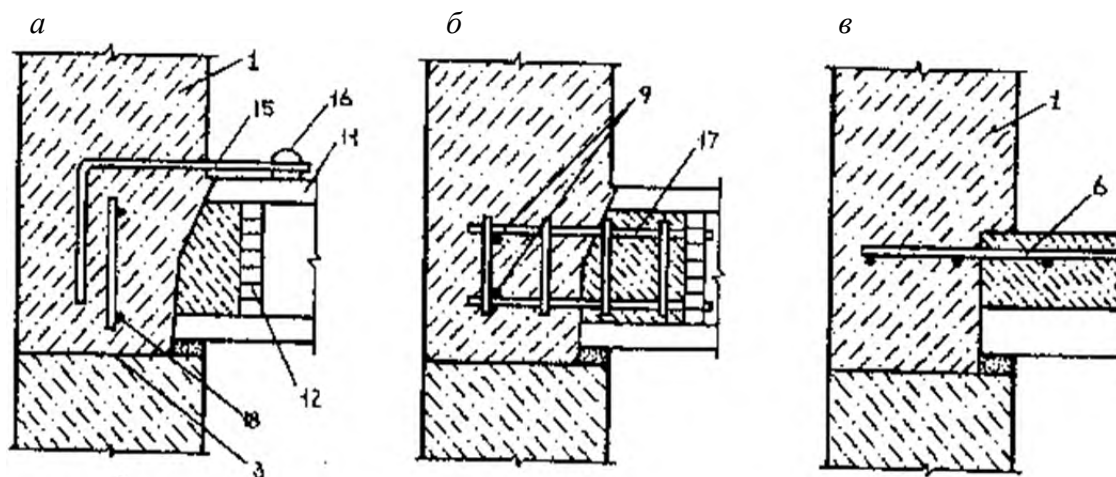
Комбинированные узлы наружных монолитных стен со сборными многопустотными и сборно-монолитными перекрытиями:
